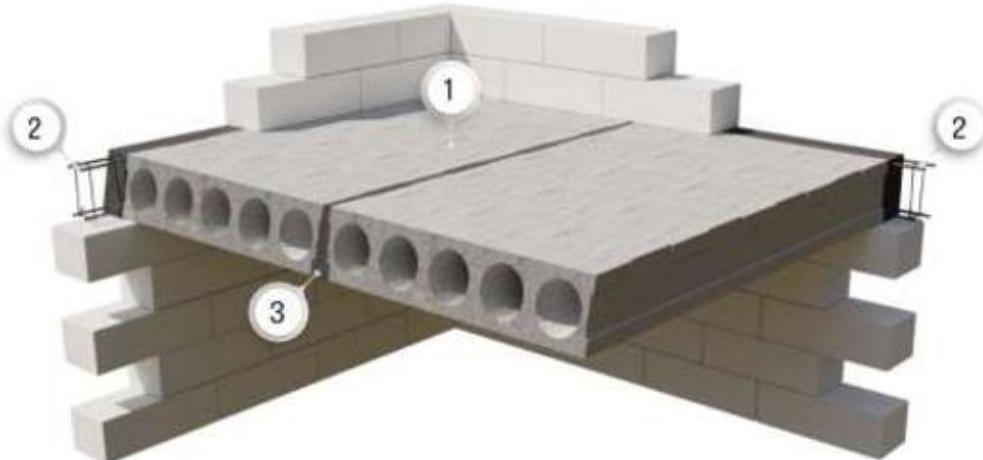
Збірне залізобетонне перекриття перекриття
